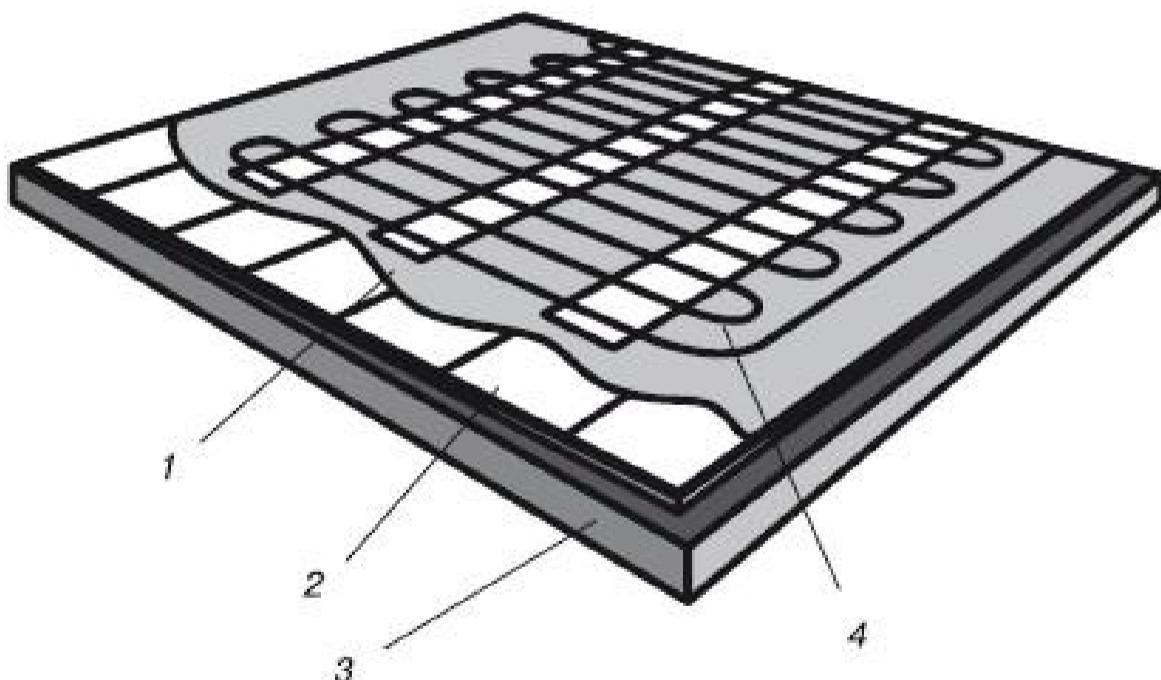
Укладка нагревательного мата на слой клея: 1 – грунтовый слой клея; 2 – старая плитка; 3 – основа пола; 4 – нагревательный мат
